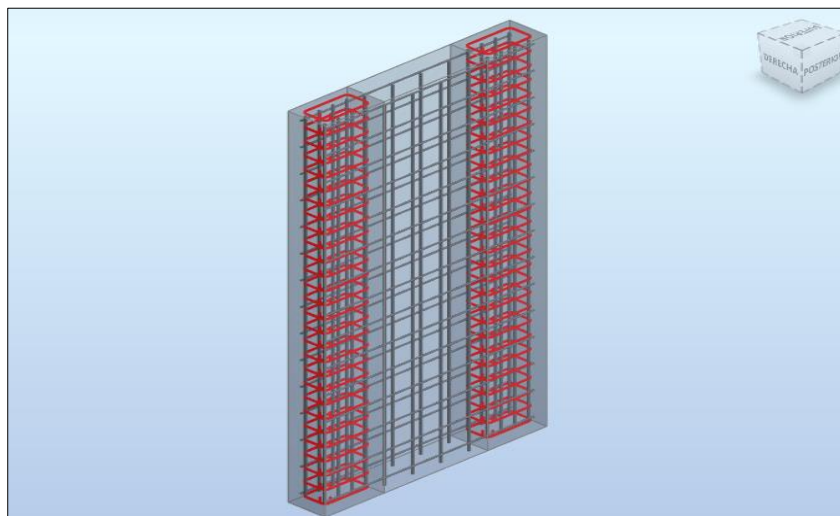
Disposición final de los aceros en el modelo tridimensional del tramo Muro estructural PL01-01
